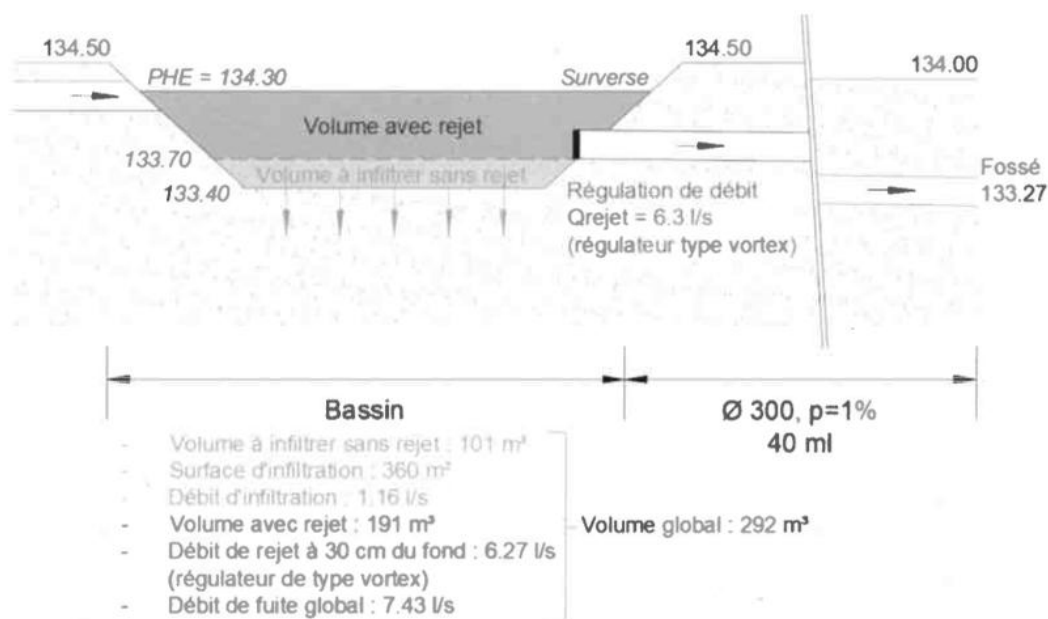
Coupe de principe du dispositif de gestion des eaux pluviales
